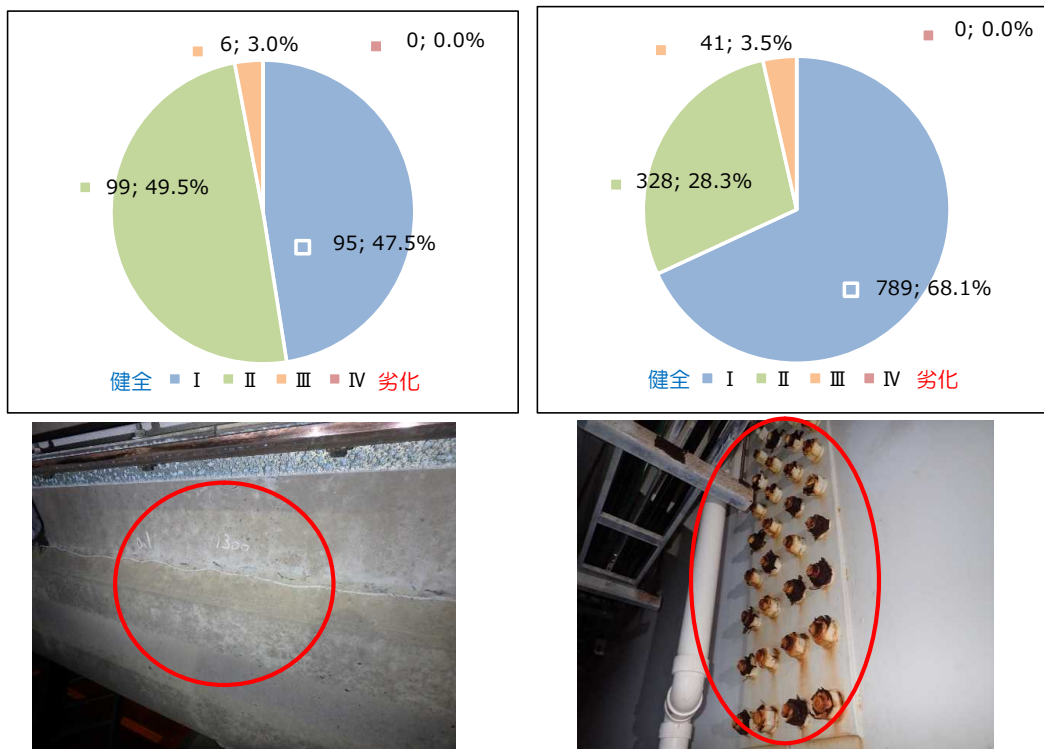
コンクリート部材（左）及び鋼部材（右）の劣化状況
